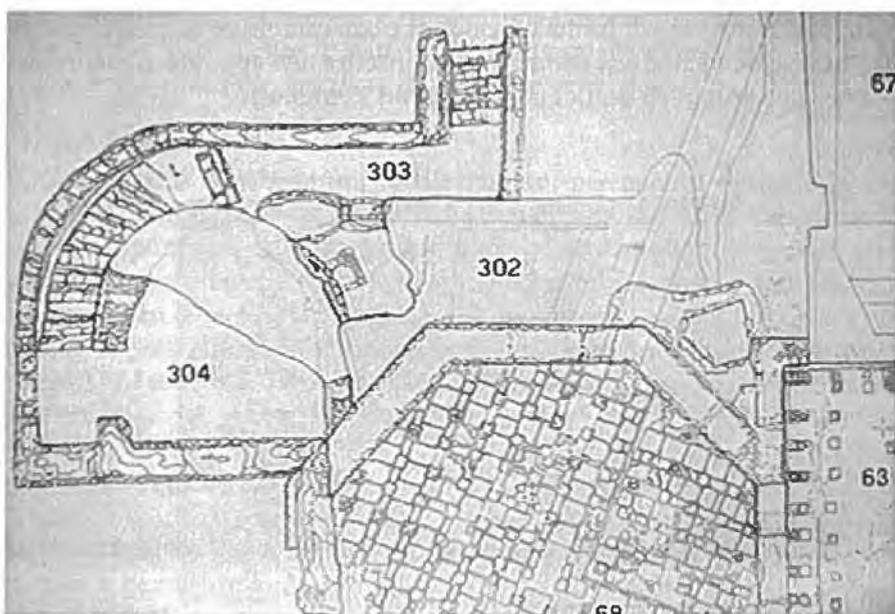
Baia, Parco Archeologico, planimetria di dettaglio, porzione di un originale in scala 1:50.
